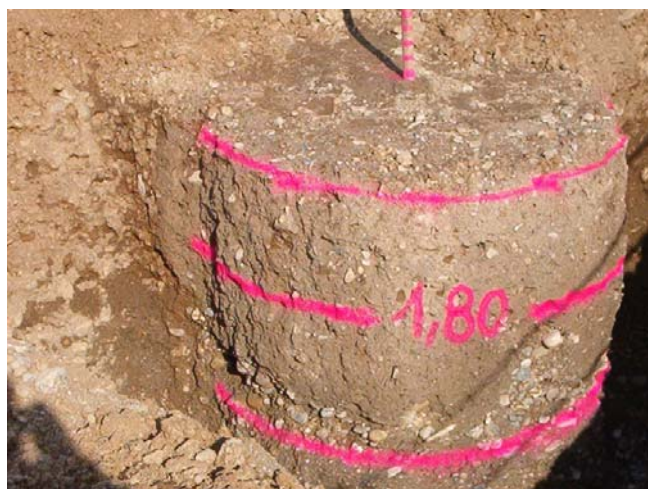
Tipico esempio di colonna di terreno consolidato con la tecnica Soilcrete (Keller)
